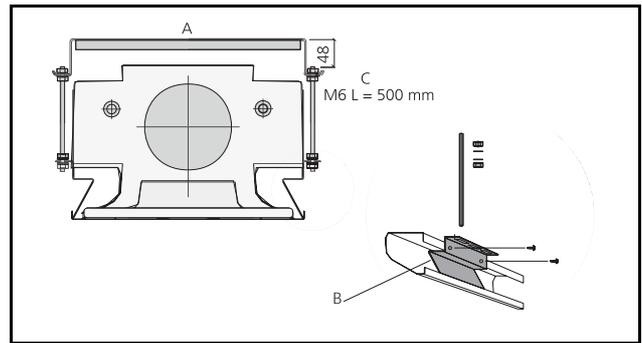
Fixation au plafond Kit de montage M10S, Vue d'extrémité.
